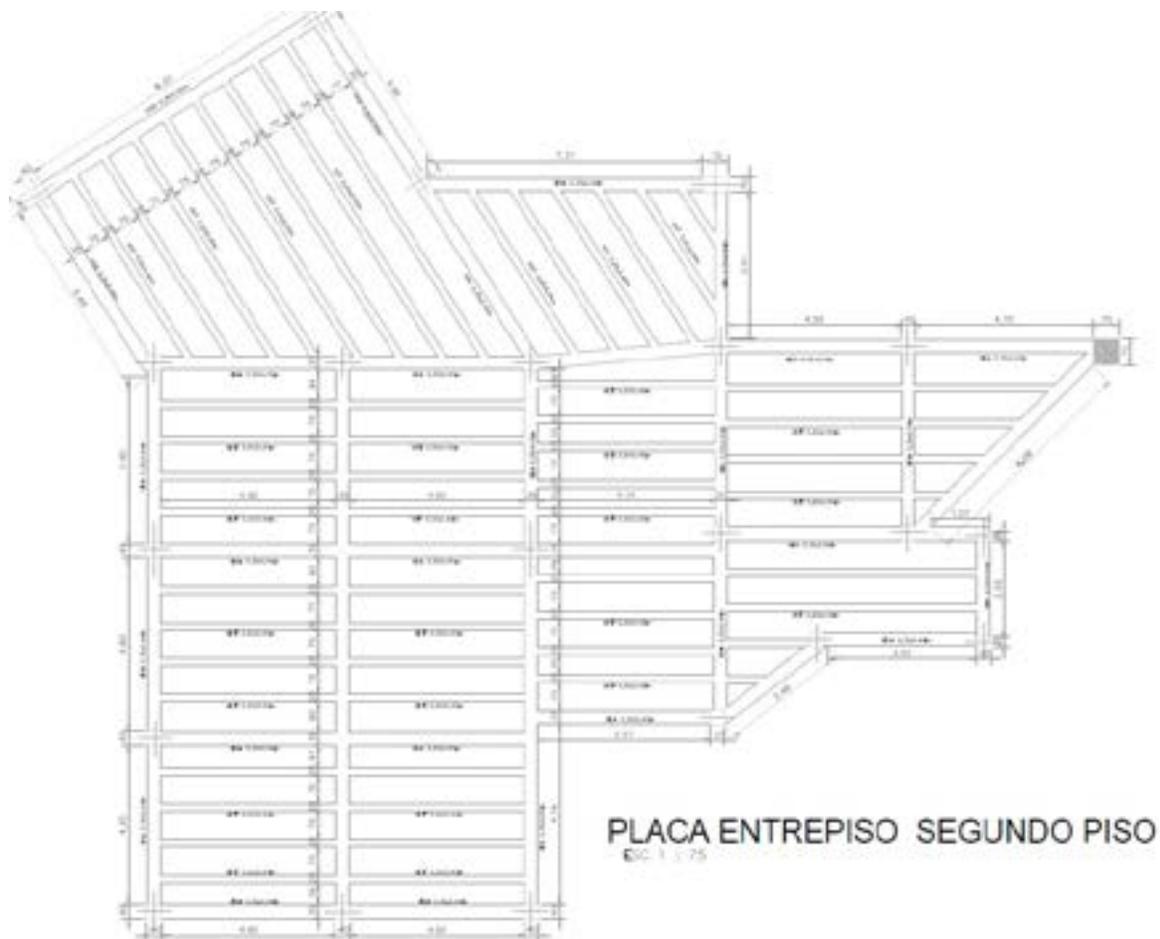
Detalle en planta placa de entrepiso segundo piso
